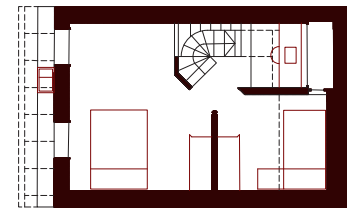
Planta intermédia tipo B Ilha da Bela Vista - LAHBSocial
